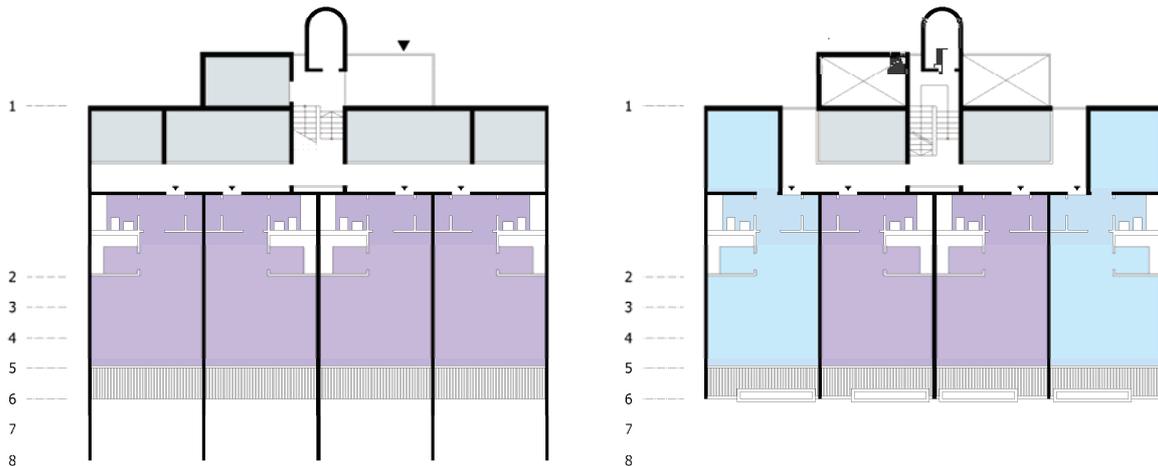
Grundrisse Bestand Typ 6/7/8/9
